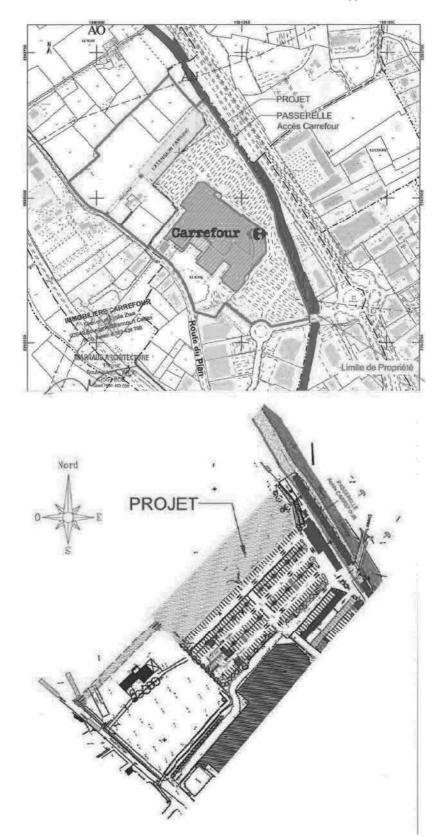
Localisation du site sur fond cadastral et zoom sur l'extension du parking
